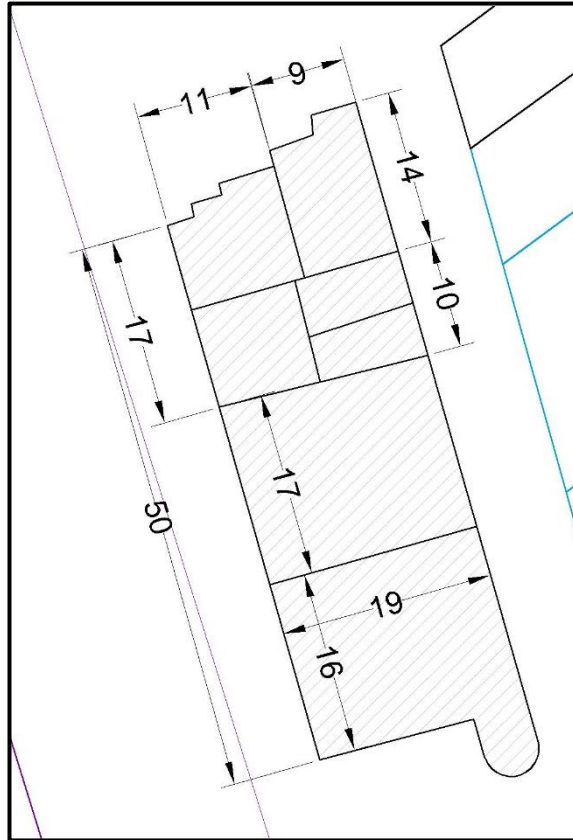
L'îlot auto-construct (Source plan cadastre traité par l'auteur)
